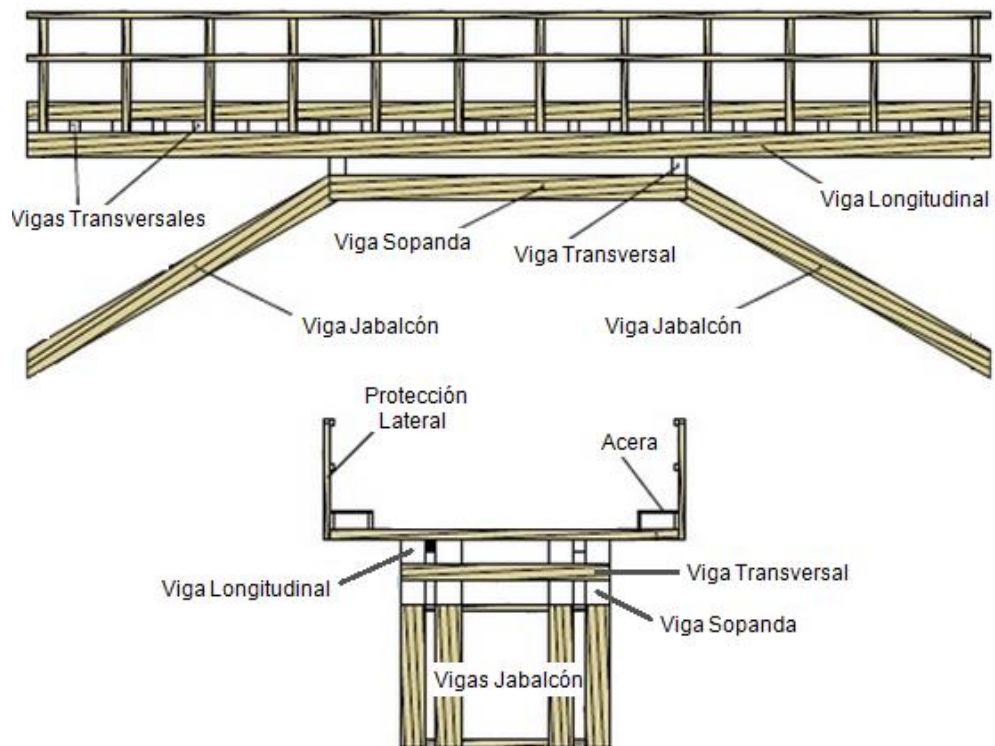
Sección transversal de vigas con apoyos intermedios mediante sopanda [13]
